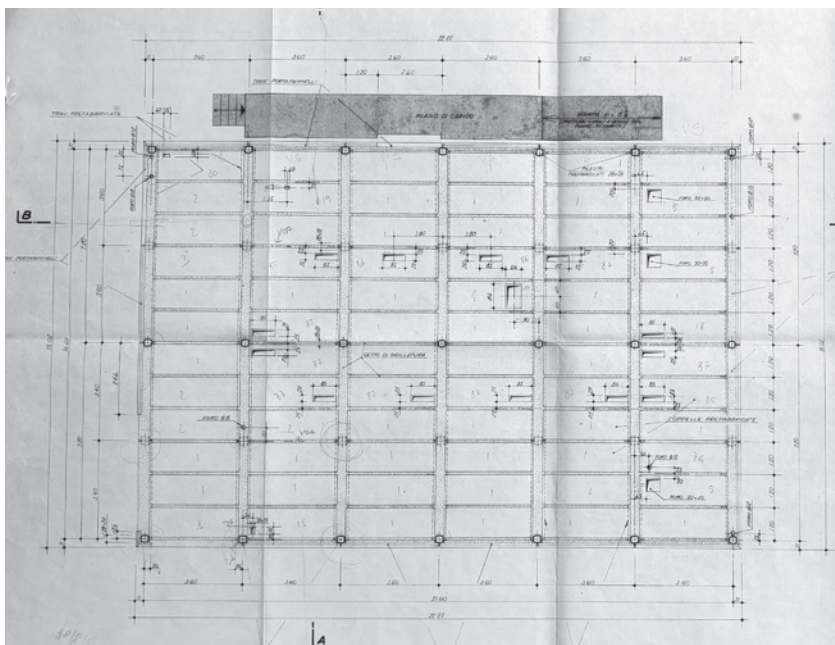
Pianta strutturale ufficio D con CTR, progetto IN.CO., 1983 (ASF, b. 147A)
